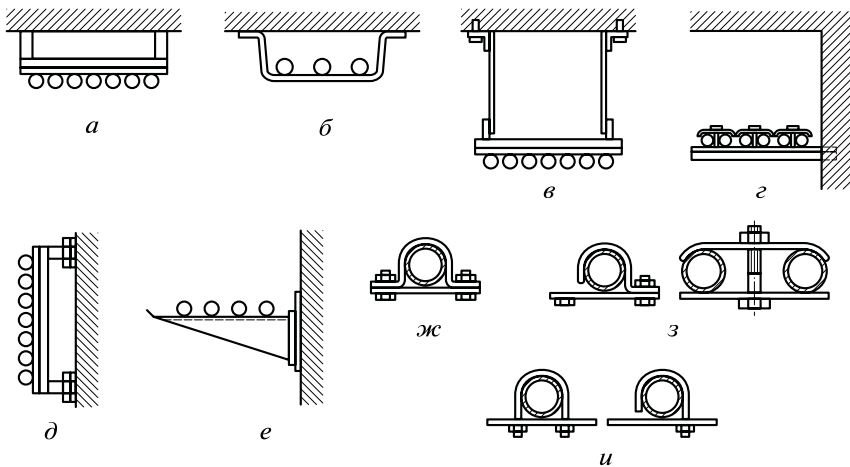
Опорные и крепежные конструкции и детали для трубных проводов:
